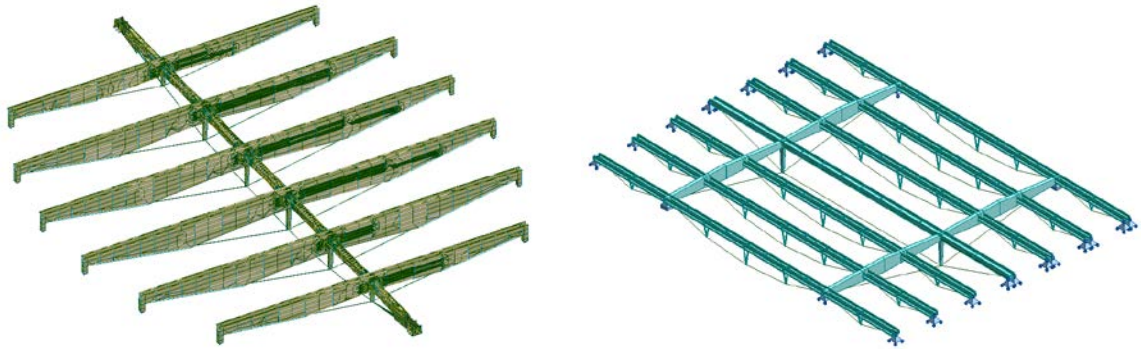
Comparación de la cubierta del Jouventut de Badalona, Agustí Obiol Estructura con la Cubierta del Gimnasio en San Carlos, Venezuela. Esteban Tenreiro y Robert Brufau, Estructura. Fuente: Autor
